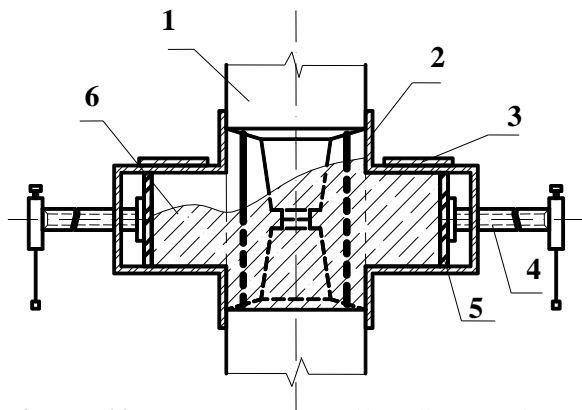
Betonarea rosturilor dintre coloane în cofraje de presare:
